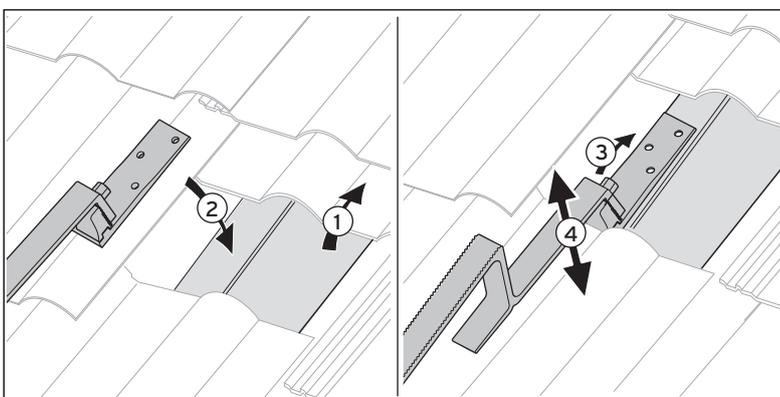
Position des Dachankers Typ P auf dem Dachsparren festlegen
